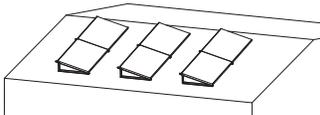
Ejemplo de instalación con marco de tejado plano tipo B
